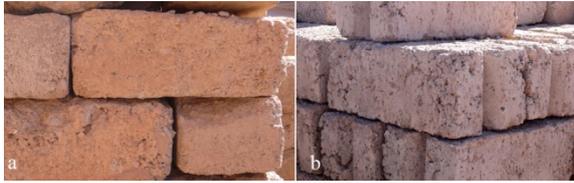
Distintos piezas de bloques según su material de fabricación. a) bloque tierra y b) bloque de hormigón.
